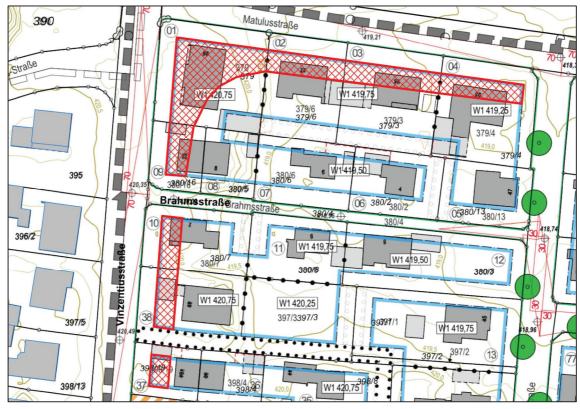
Lageplan mit Darstellung der von Schallschutz betroffenen Parzellen 1-4, 9+10 und 37+38
